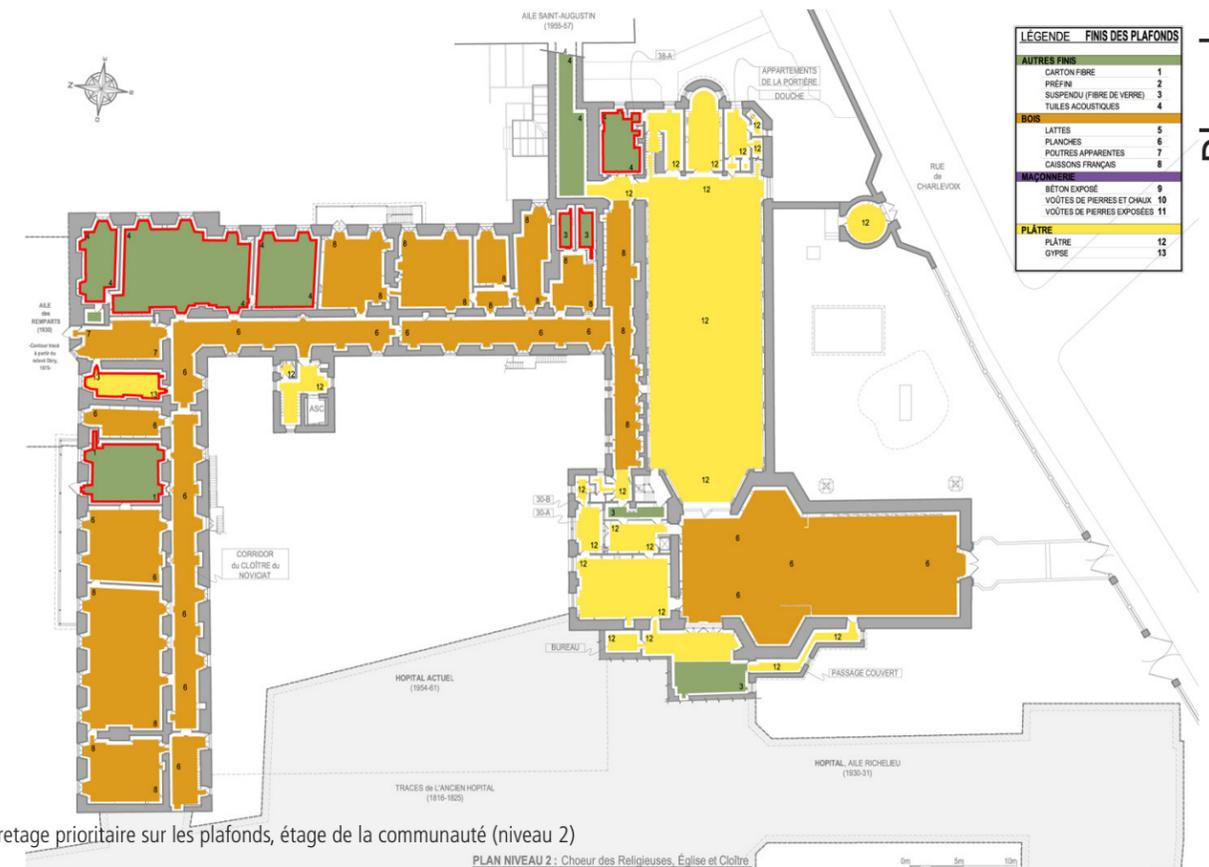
Plan de curetage prioritaire sur les plafonds, étage de la communauté (niveau 2)
